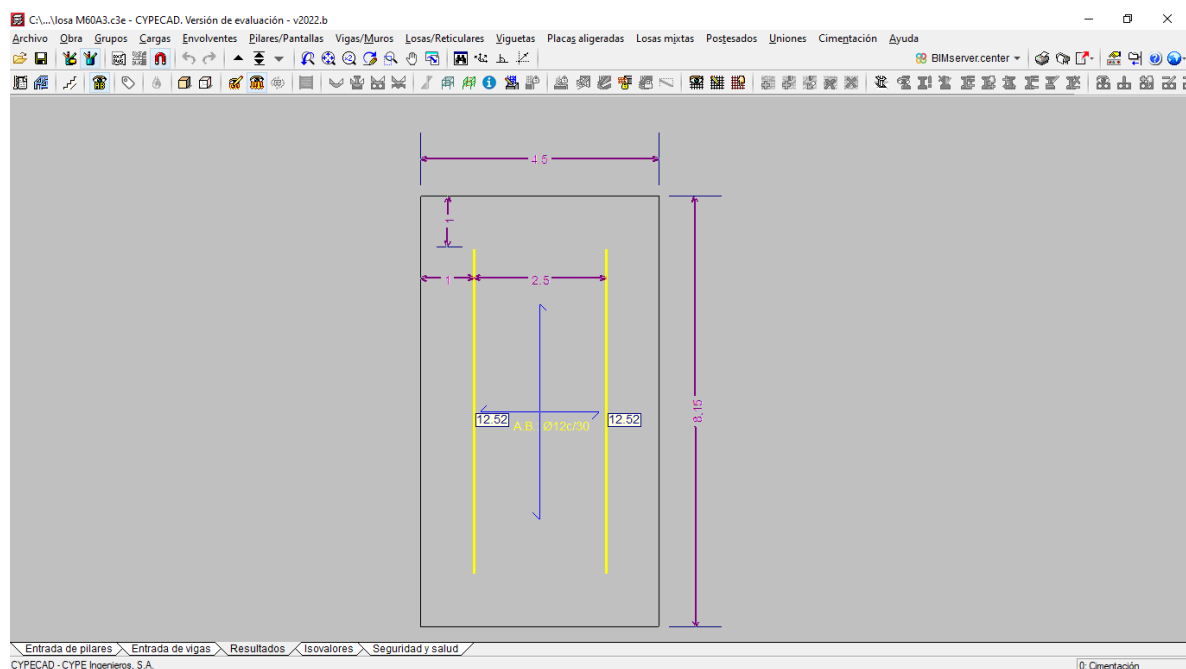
Cálculo armado losa BMR (Fuente: elaboración propia)
